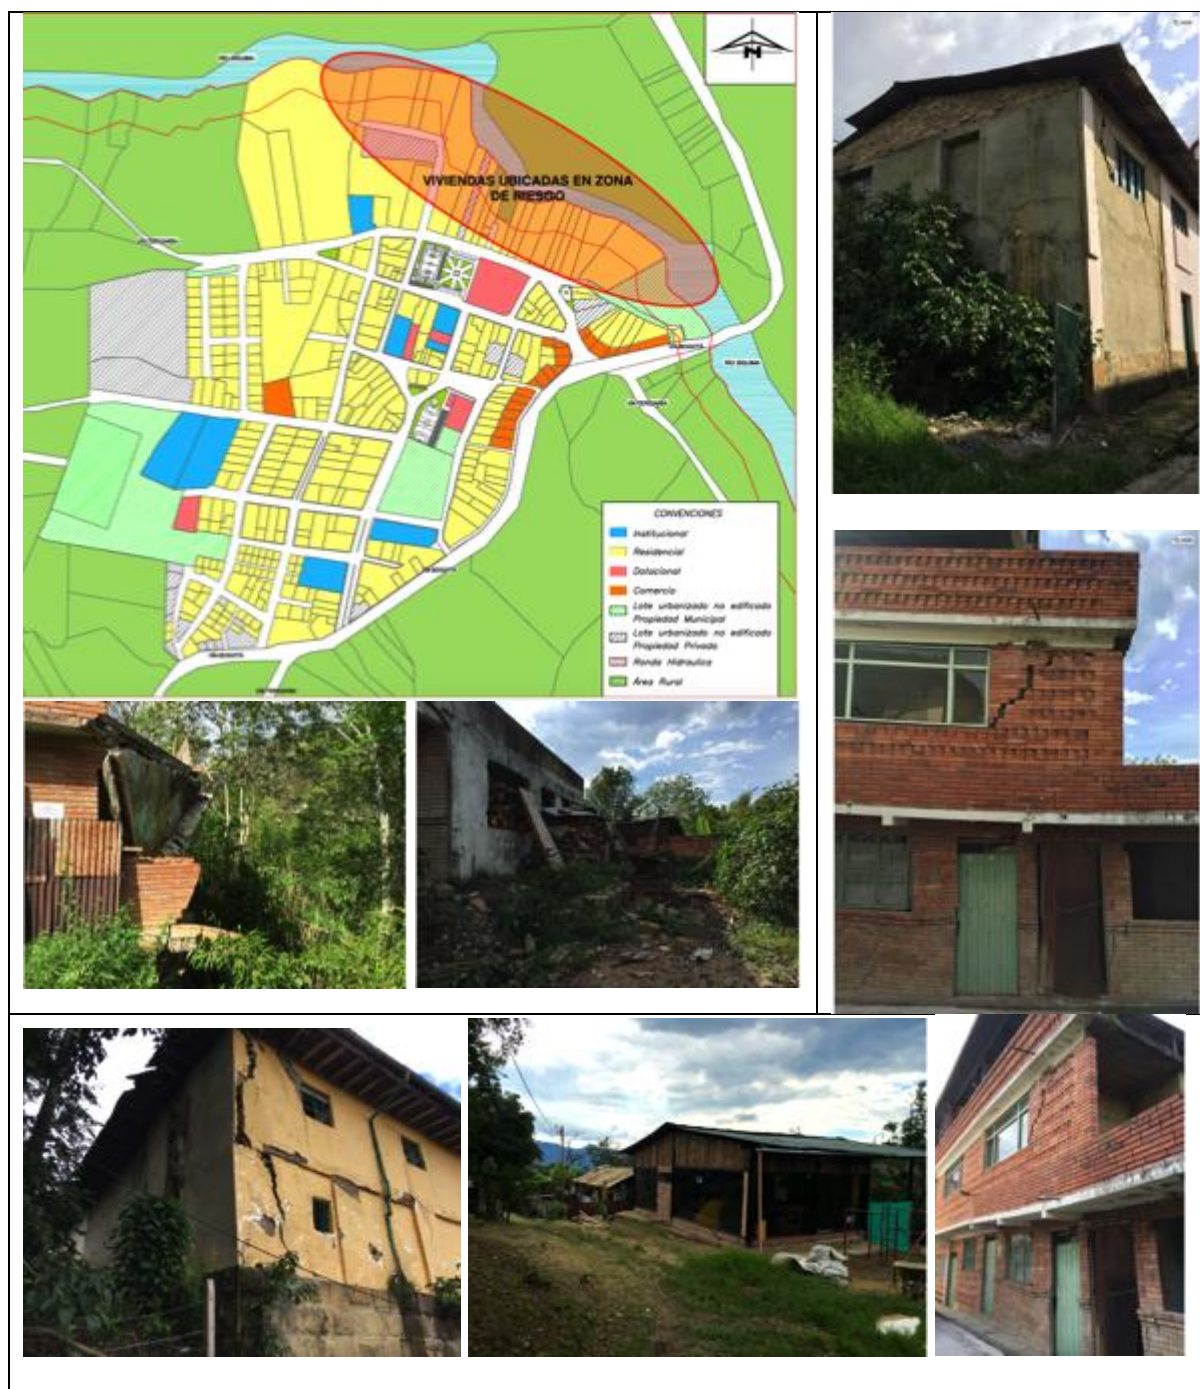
Viviendas Ubicadas en Zona de Riesgo por Deslizamiento
